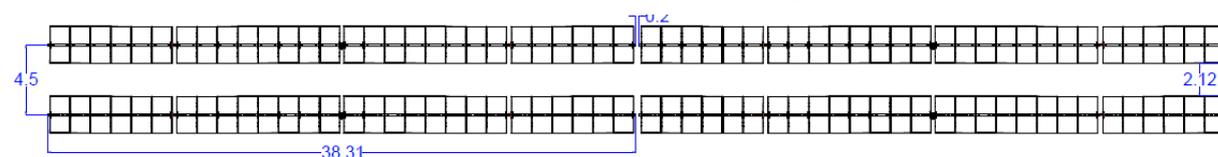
Vista in pianta di quattro tracker (quote espresse in metri)
